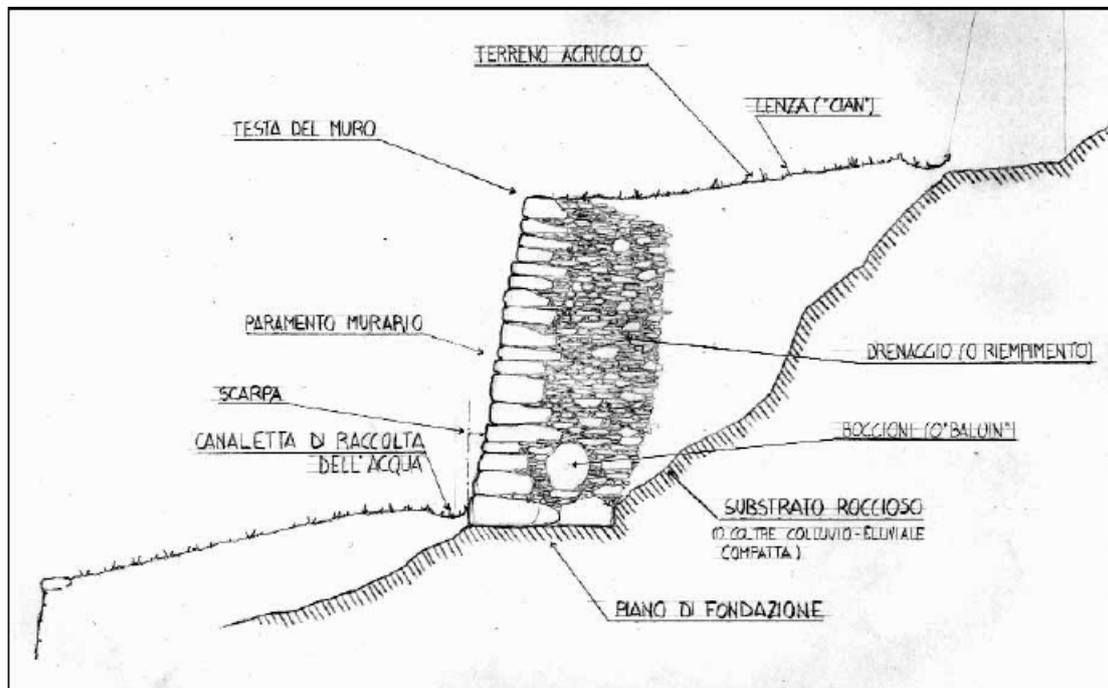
tipologico per costruzione di muretto a secco
